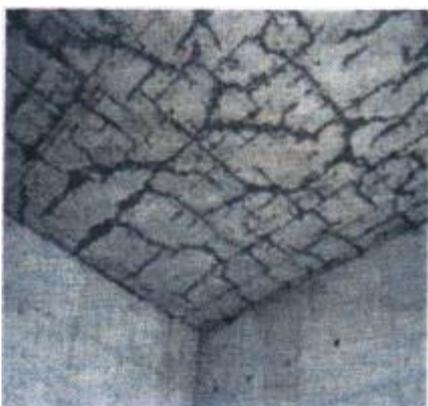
Fisuras por contracción impedita de origen térmico en un muro.
